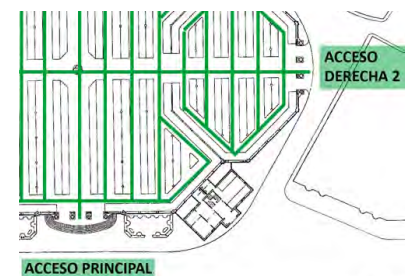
Plano detalle de la entrada ACCESO DERECHA 2 por la calle Vell de la Palla
